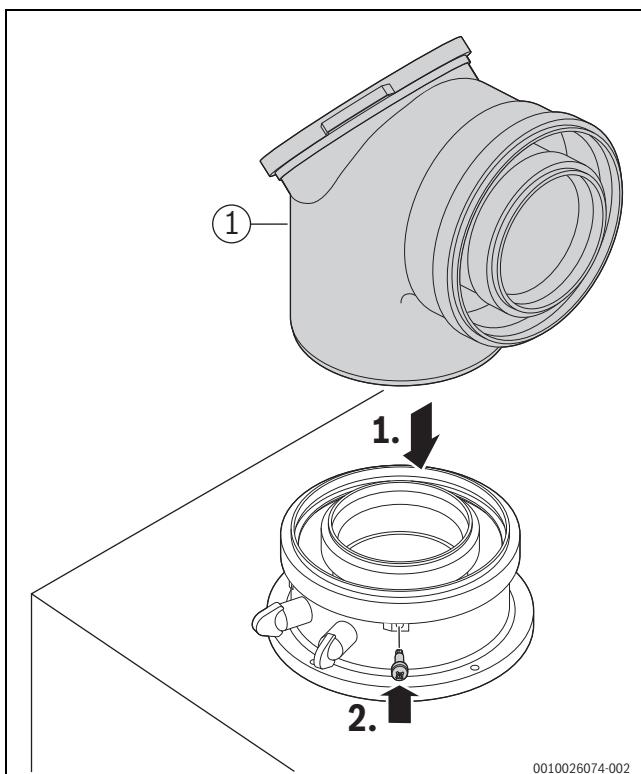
Abgaszubehör einsetzen und mit Schraube sichern
